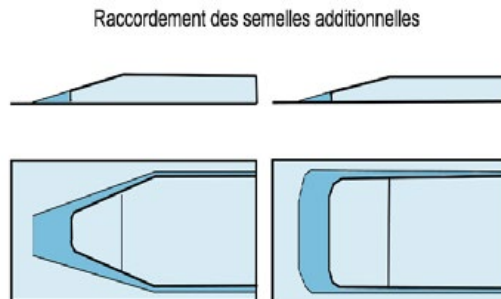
raccordement des semelles additionnelles recommandé (document Jean-Paul PERSY).
